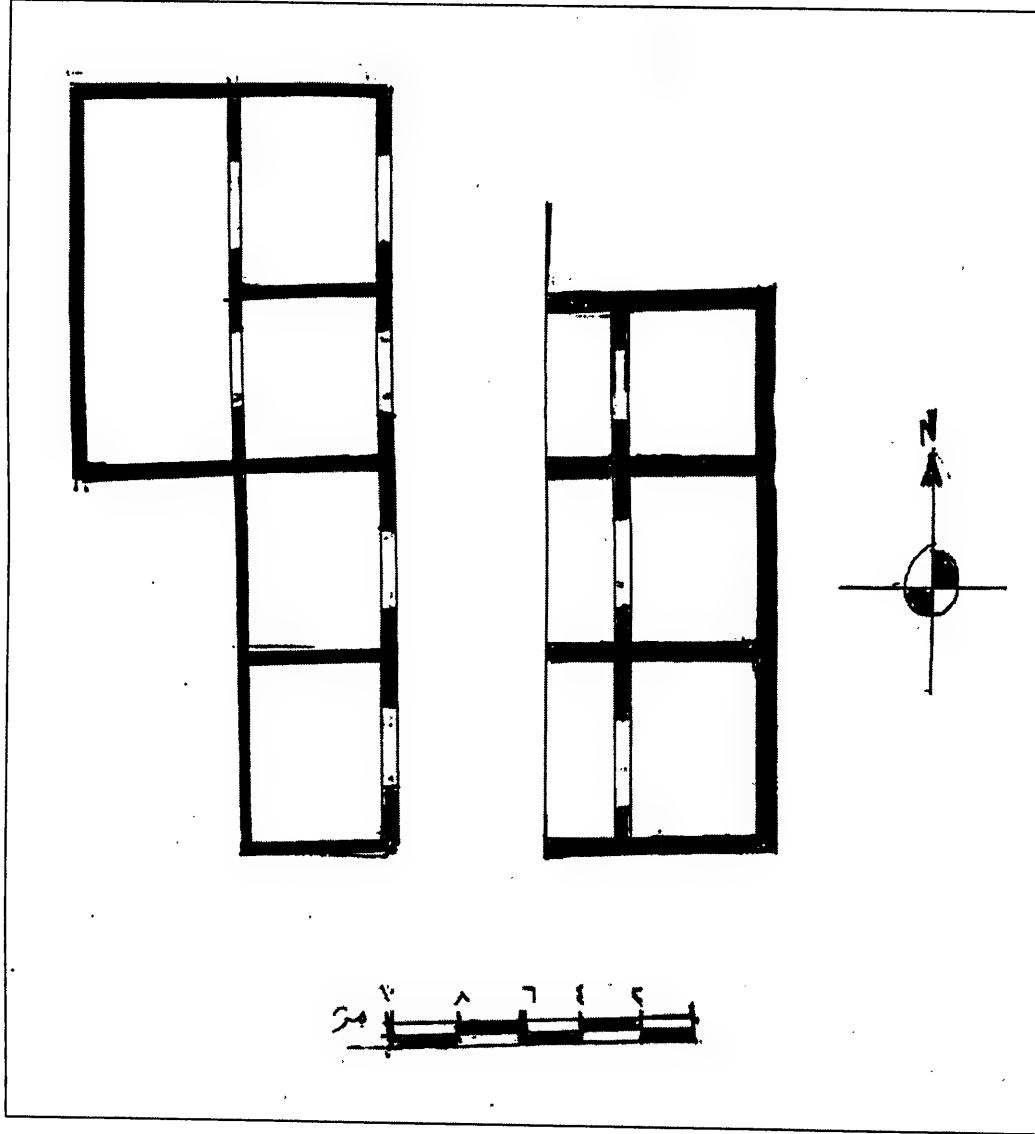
مسقط أفقي لبقايا المبنى السكني (ب) بمدينة الجميرا
